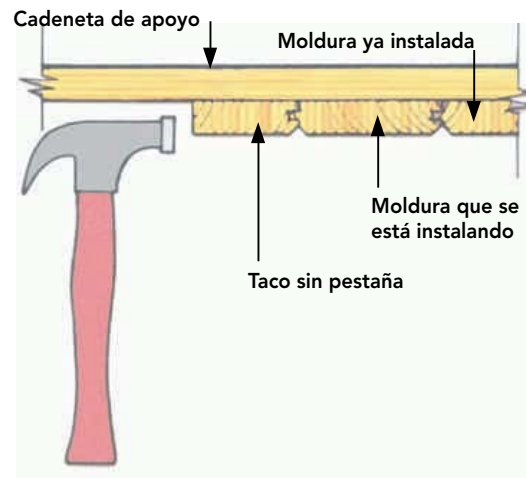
32: Corte de tabique donde se muestra taco que ayuda a asegurar el calce entre las molduras machihembradas.
